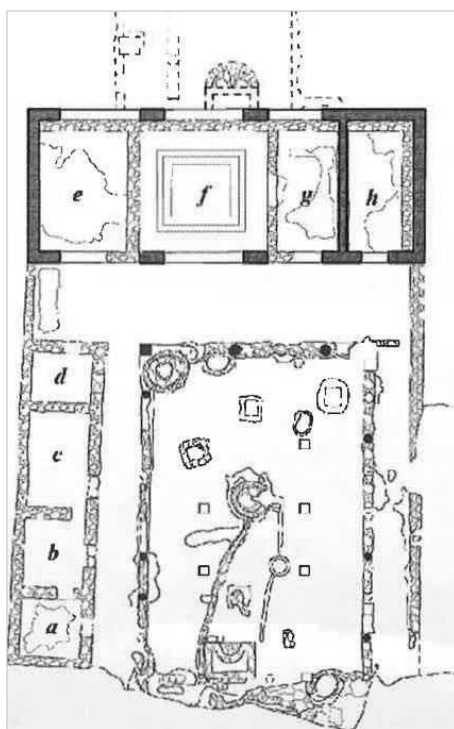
Planimetria della Domus B (Soprintendenza BB. CC).
